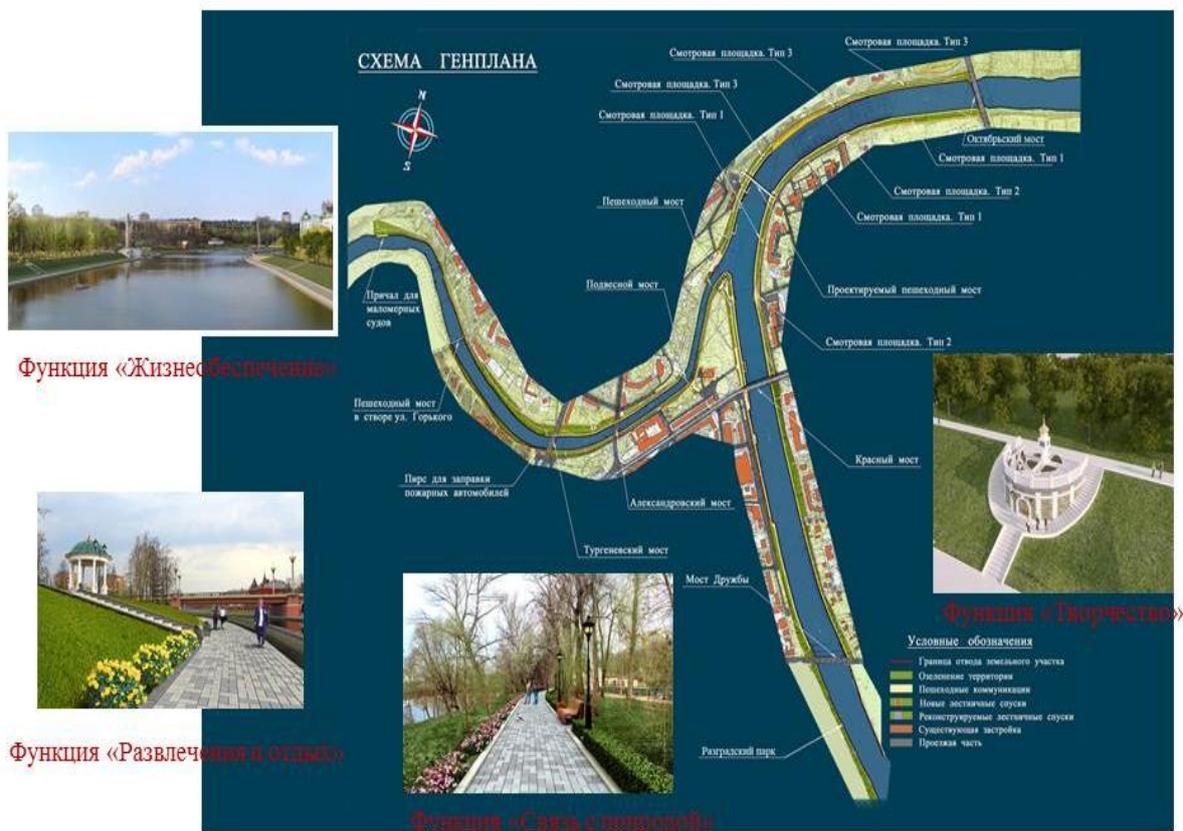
Схема генерального плана реконструкции набережных рек Оки и Орлика к 450-летию г. Орла
